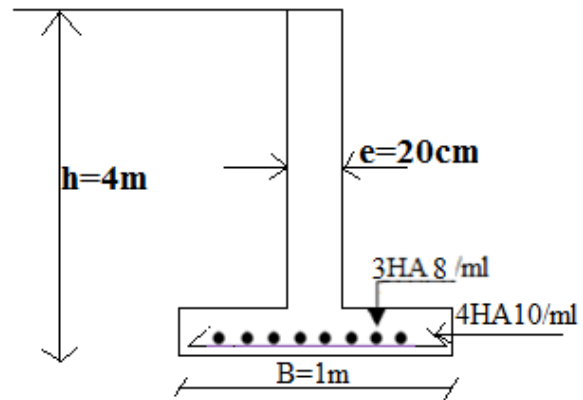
schéma de ferrailage de la semelle sous voile périphérique
